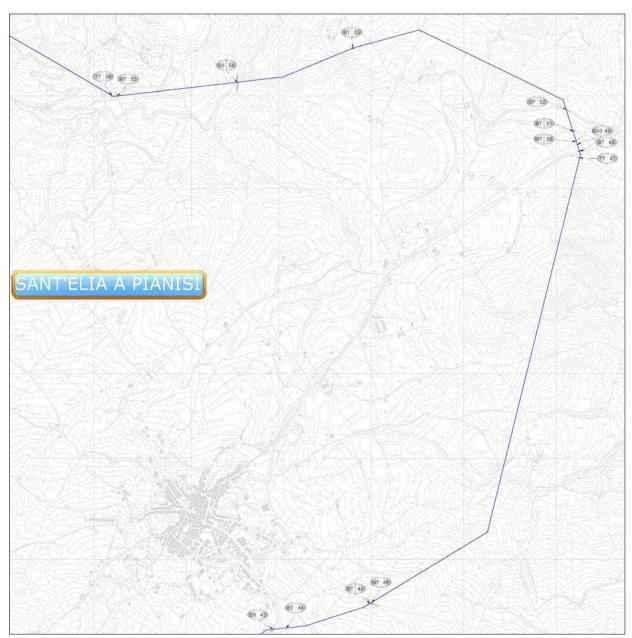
Stralcio planimetria tracciato elettrodotto su CTR (3/5)
